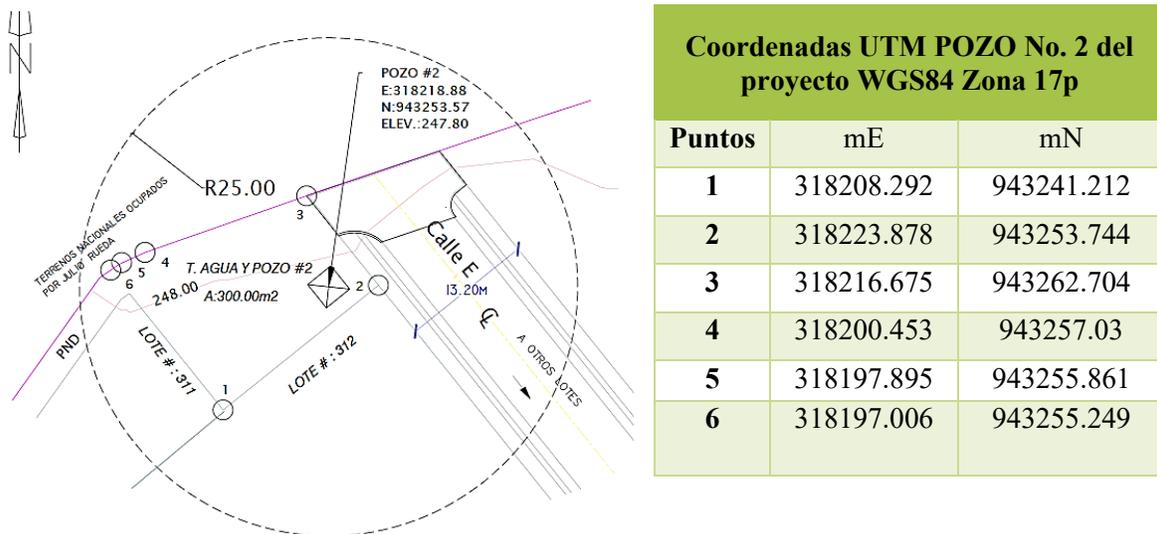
Coordenadas del pozo y tanque de reserva No. 2. Fuente: Planos del proyecto, 2023
